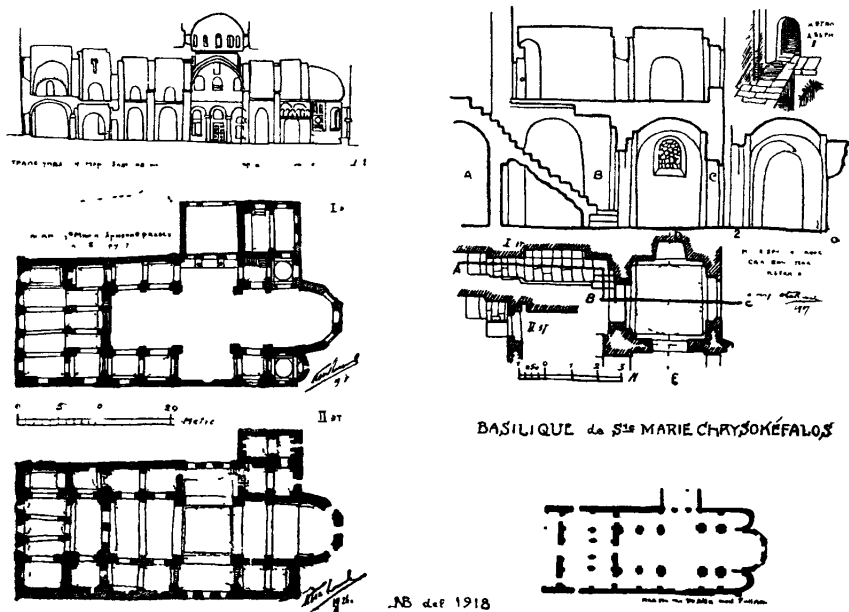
Plan du rez-de-chaussée et du premier étage. Angle nord-est et escalier.
